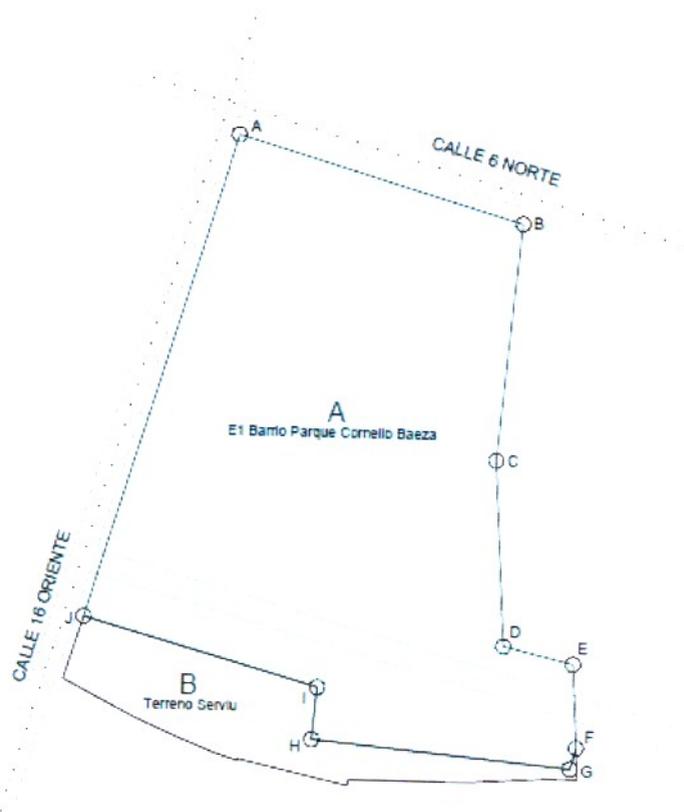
Terreno Fusionado y luego subdividido, Etapa 1 Barrio Parque Cornelio Baeza.
